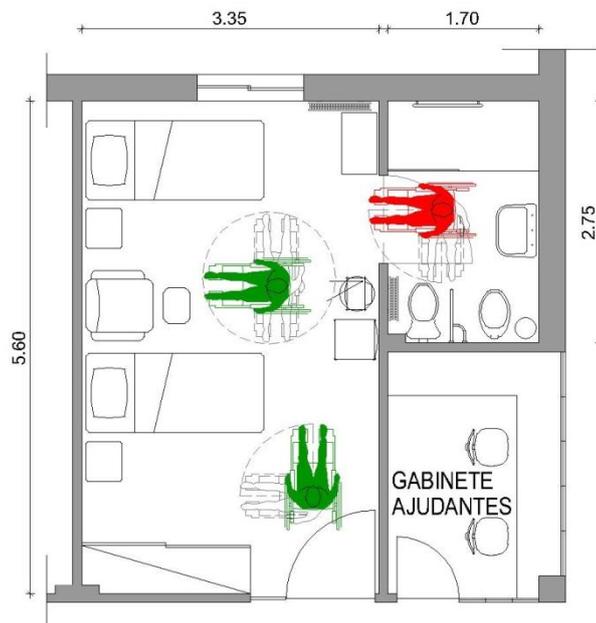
ILPI 1 - 2º pavimento - Planta baixa quarto e banheiro privado.
